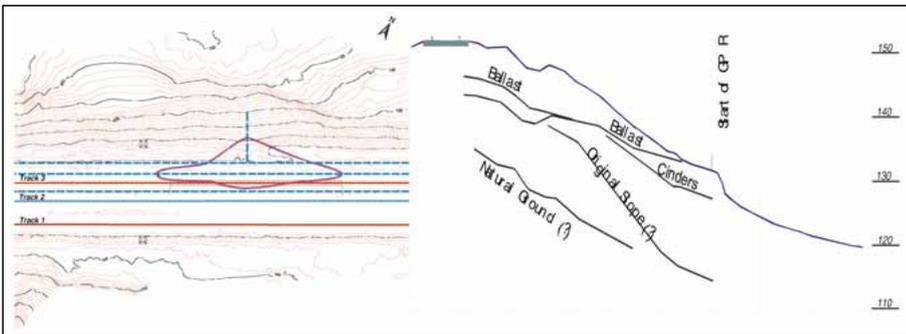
Detaillierte Konturinformationen und Querschnitte an einer Stelle mit instabilem Hang
